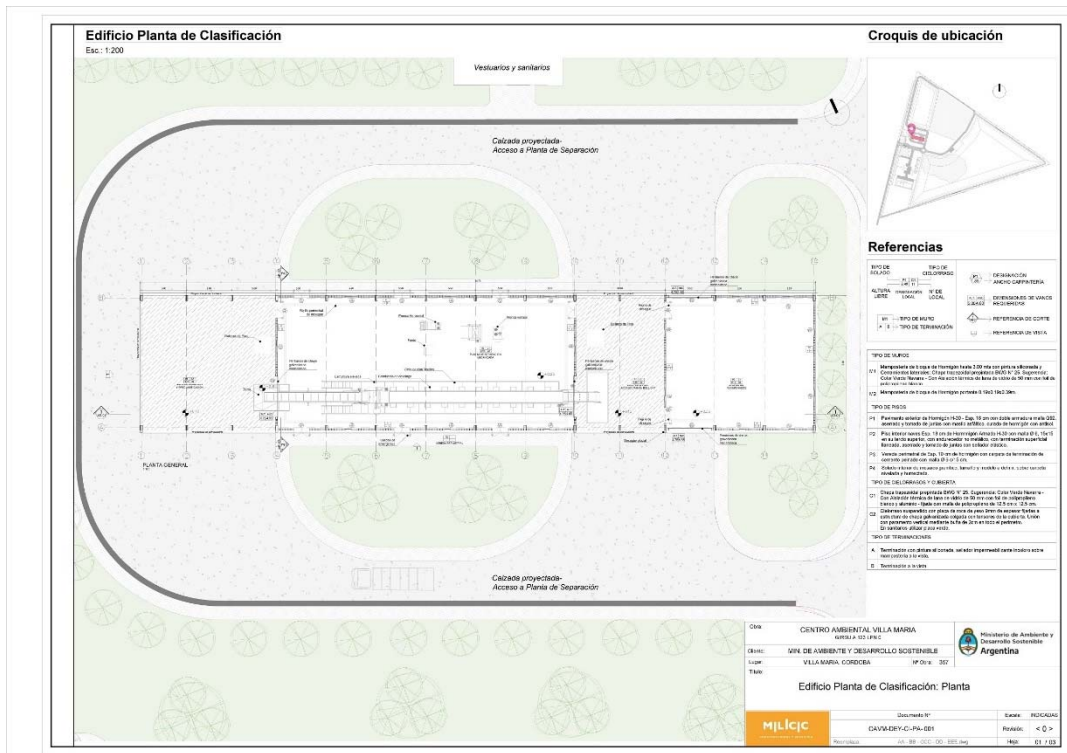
Villa María - Planta de Separación y Clasificación - Planta de Arquitectura.
